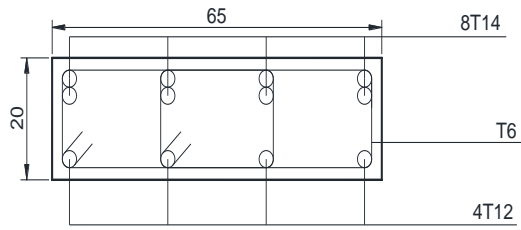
Coupe longitudinale d'une poutre noyée principale 65x20cm (bâtiment R+7)
